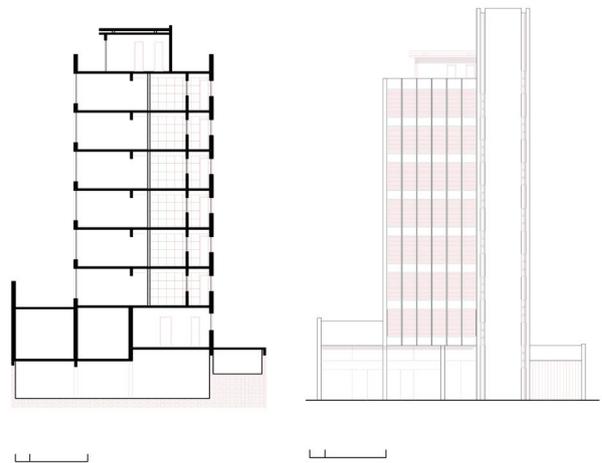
Edifício Condado de Luzerne, corte e fachada. Fonte: FAGUNDES, 2021.
